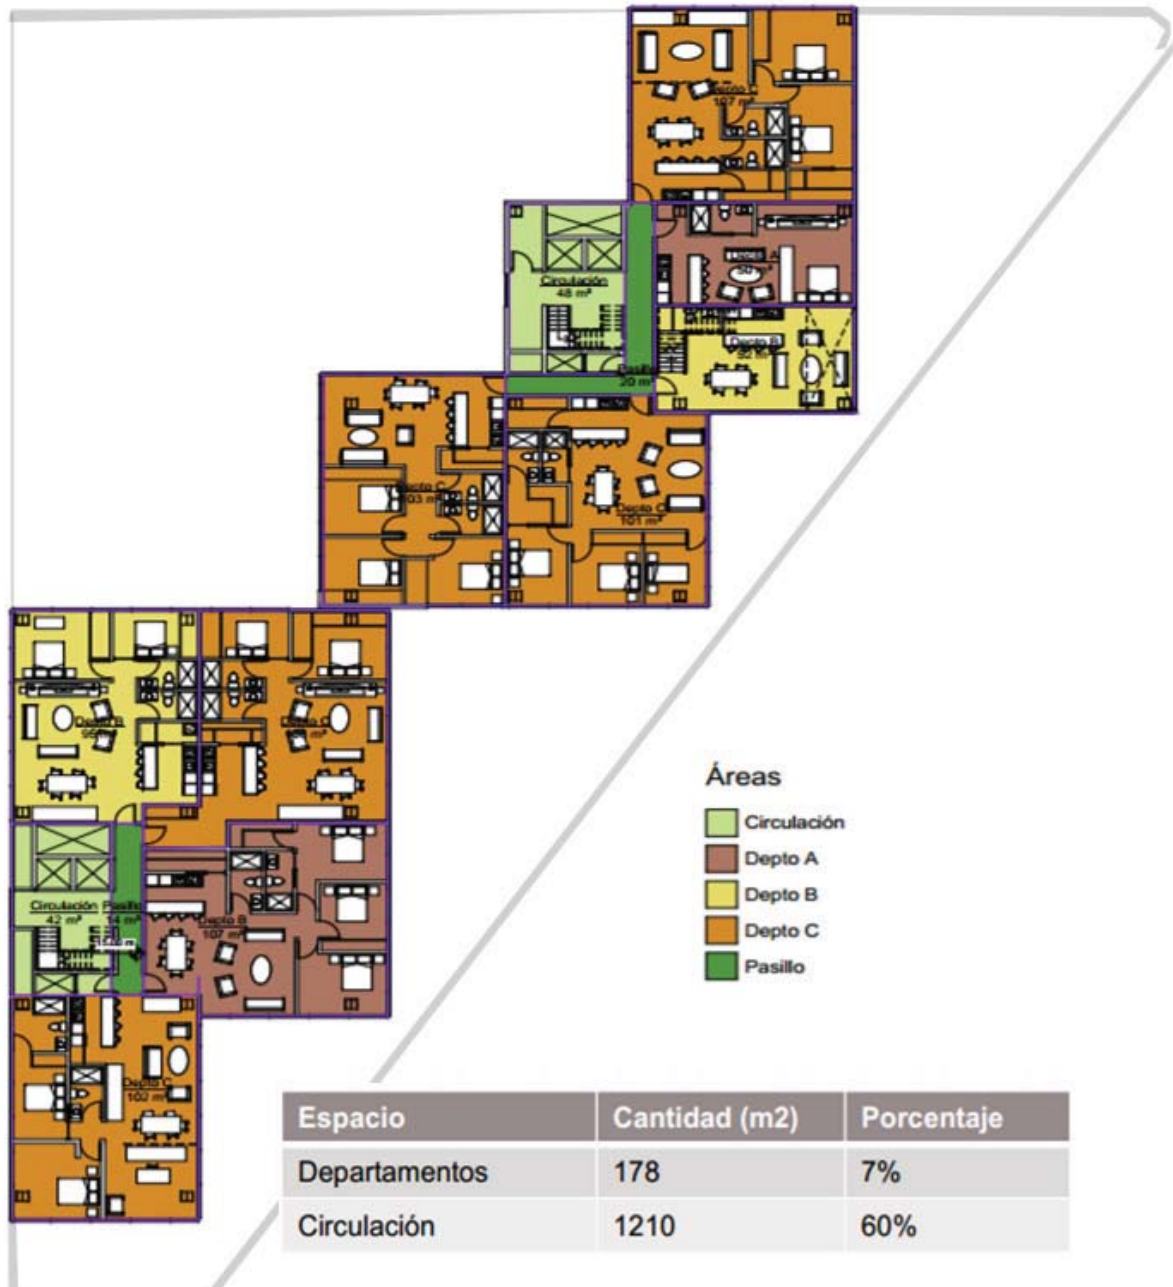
Quinto nivel. Planta de vivienda. En ella se hace el desarrollo de viviendas con 1, 2 y 3 dormitorios.
